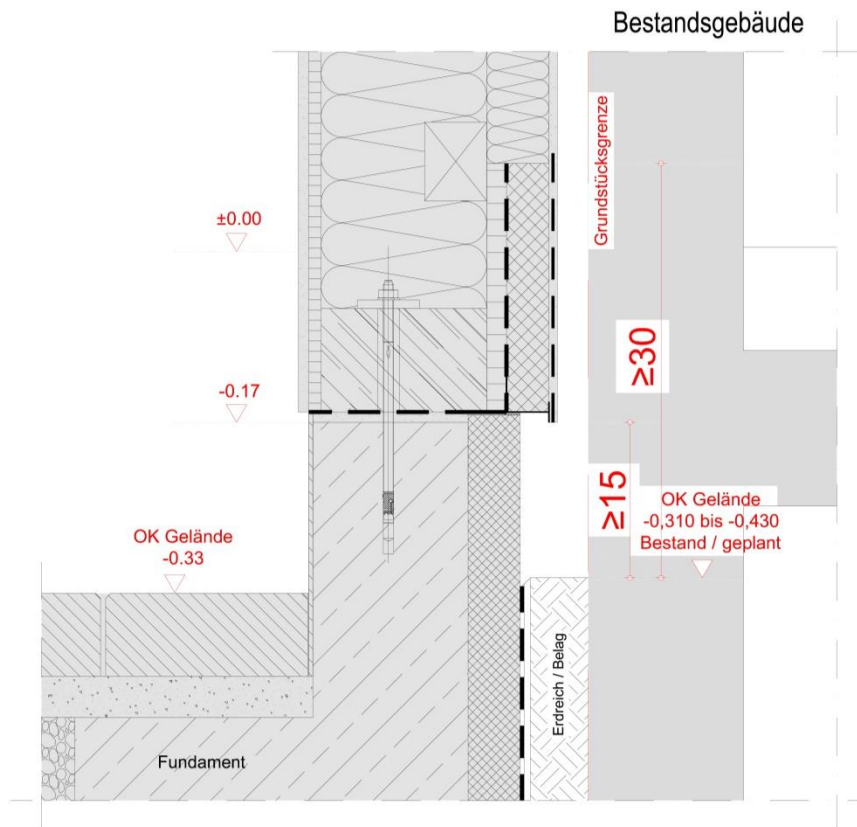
LUXHAUS Sockeldetail 16 - Garage mit Betonaufkantung, Bebauung an Grenze mit Bestand
